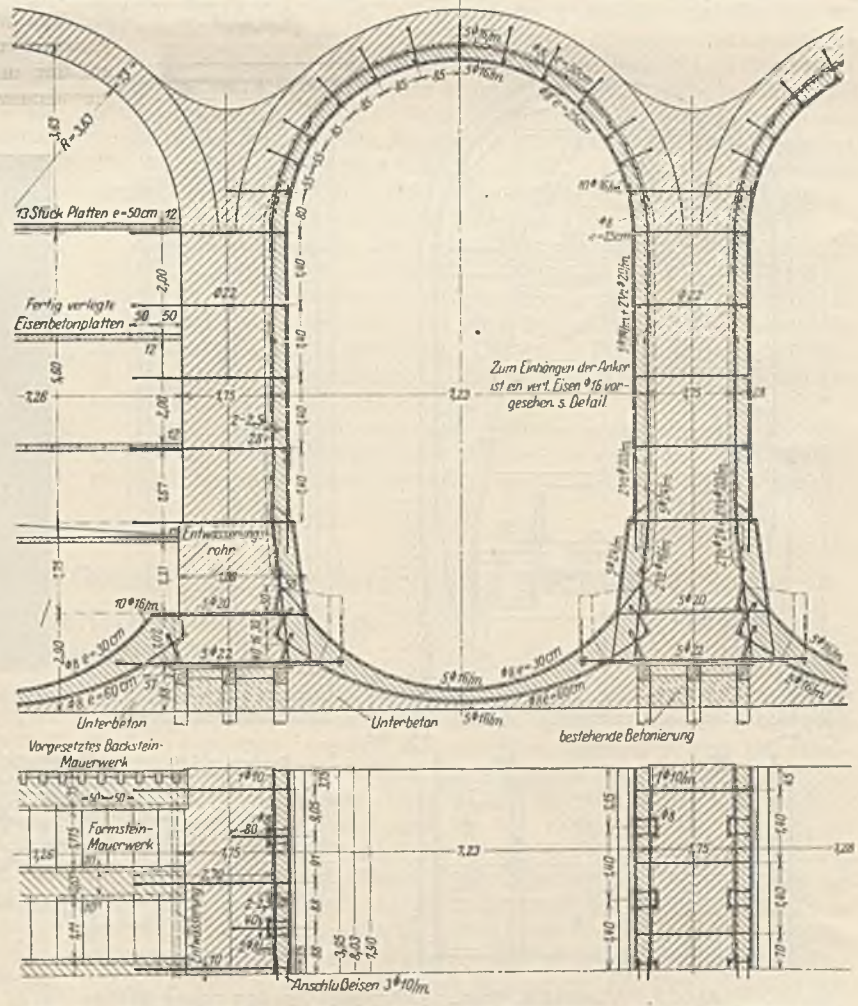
Viadukt Kläham. Konstruktion und Bewehrung des neuen Einbaues.
